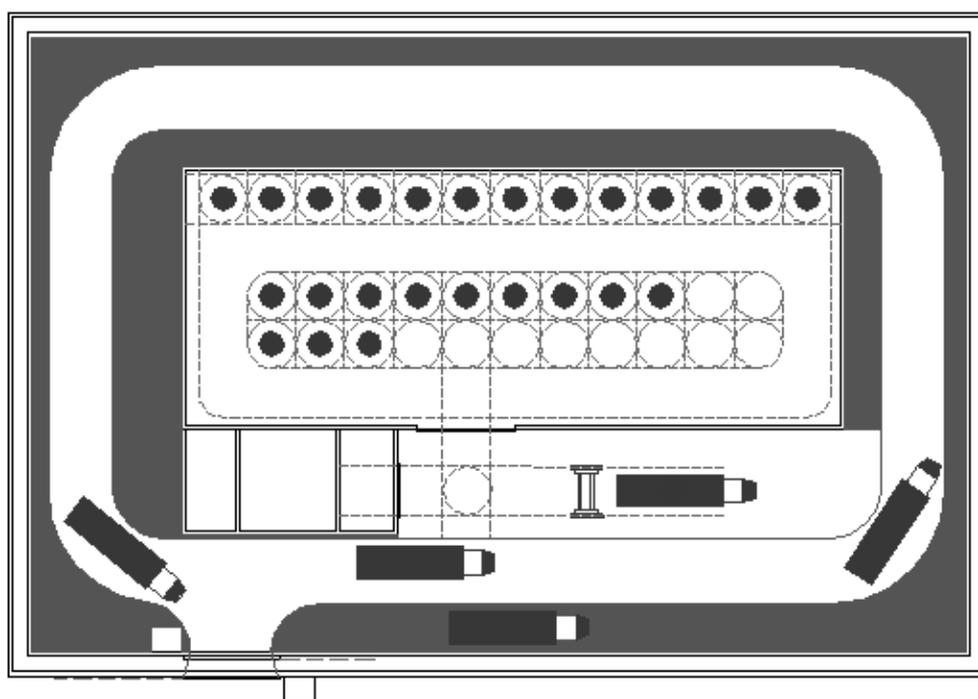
Planta de uma instalação de armazenagem para cascos de concreto em área aberta.
